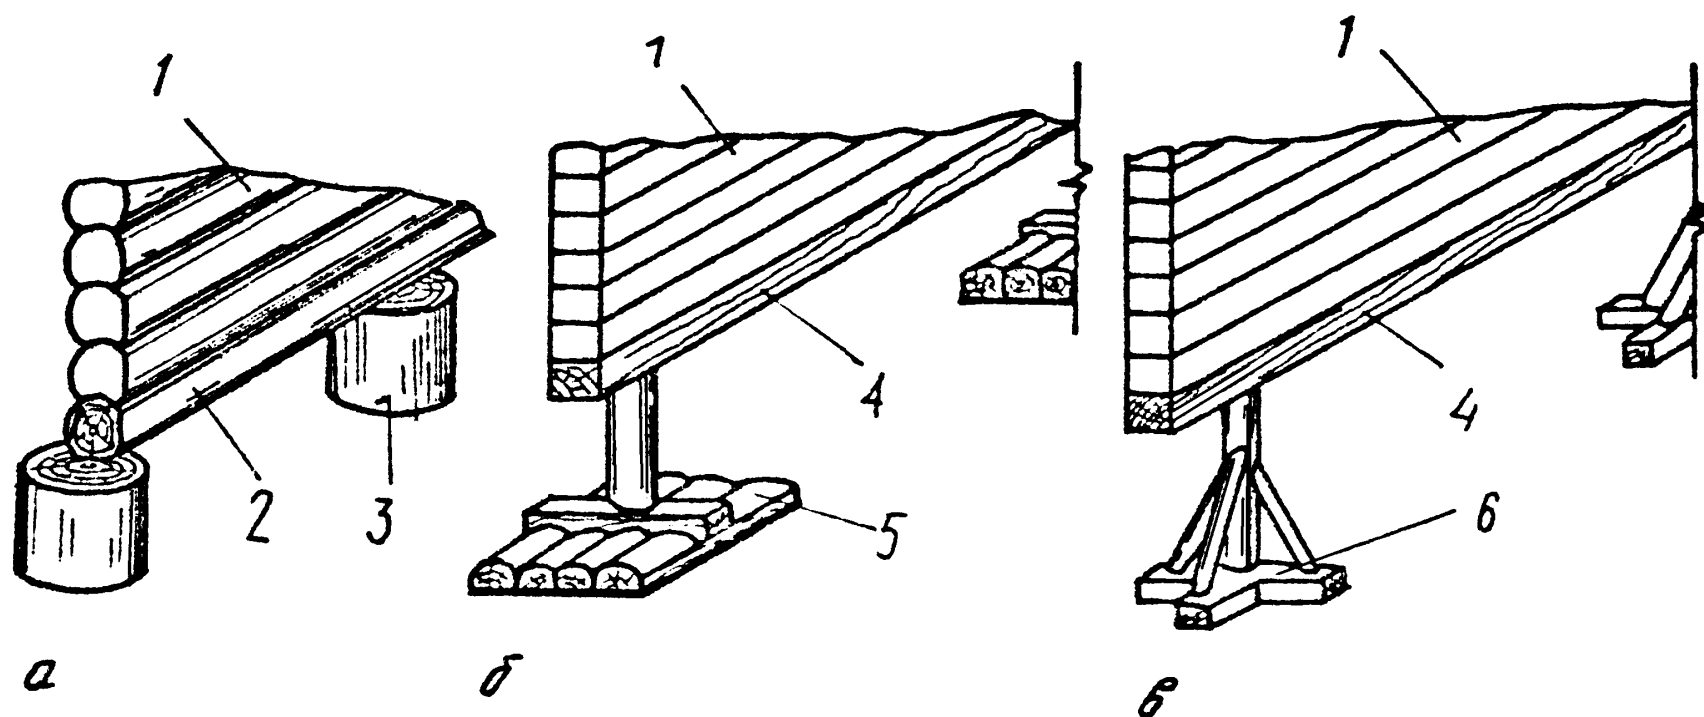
Конструктивні схеми стовпчастих дерев'яних фундаментів:
